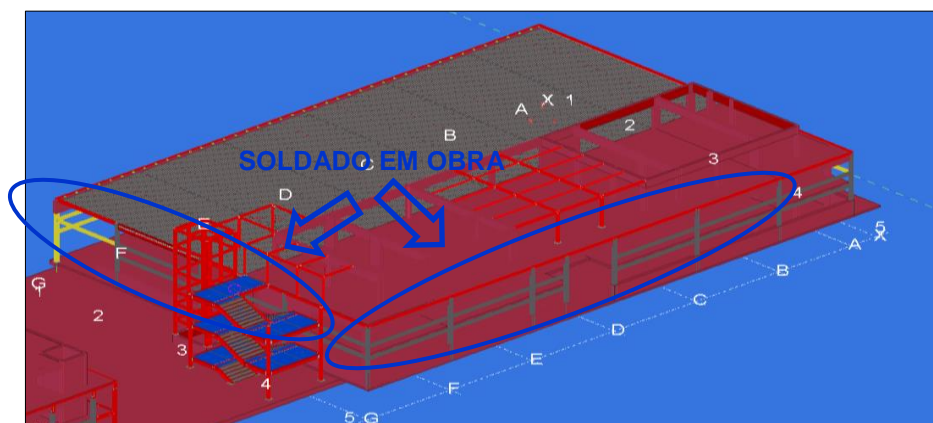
Soldadura realizada em Obra no Edifício BBC
